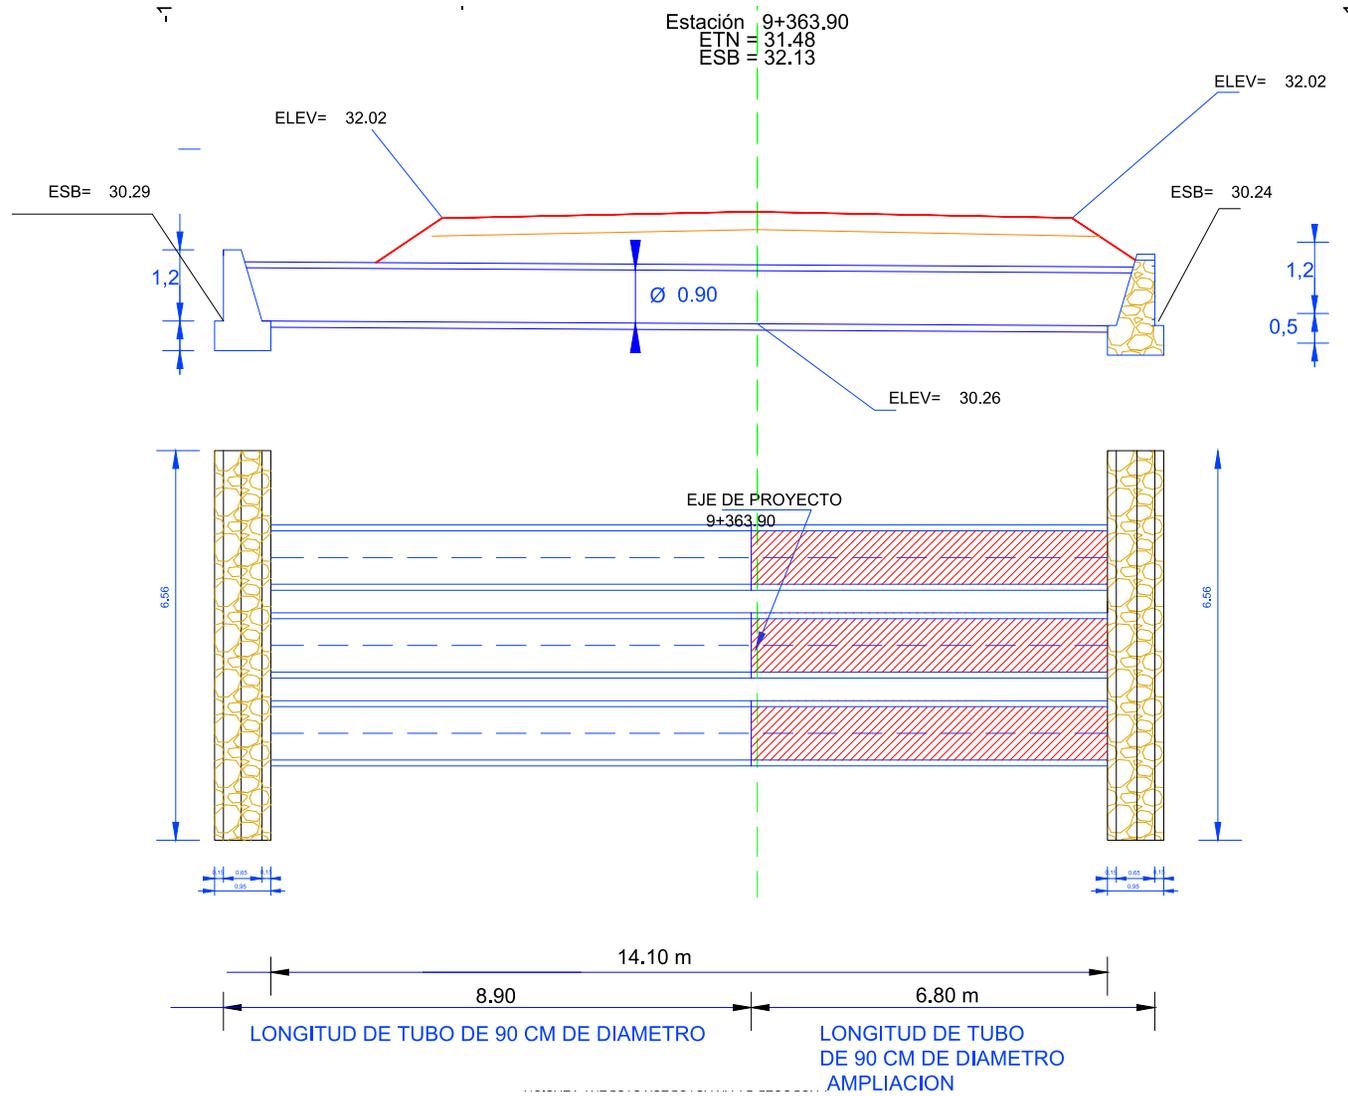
Sección en planta para la colocación de tres tubos de concreto
